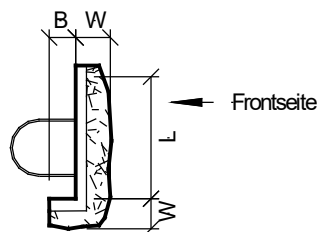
Grundriss Eckstein links (längerer Schenkel auf der Frontseite, kleinerer links)
